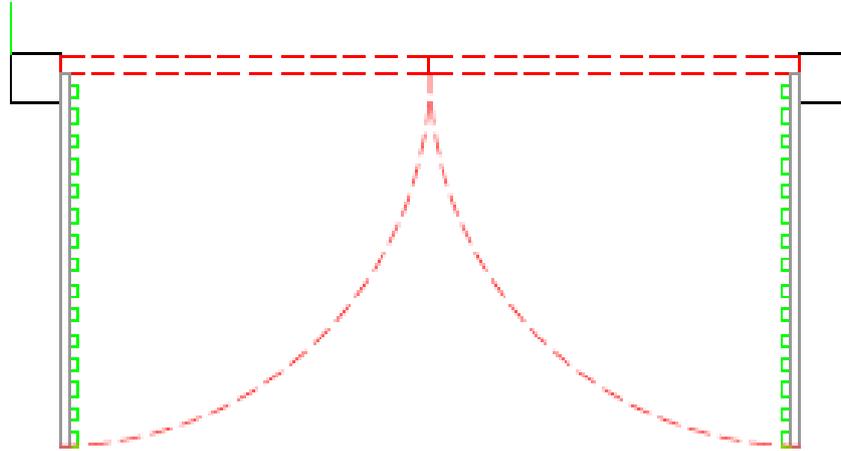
Vista en planta de la puerta batiente a doble hoja de garaje, en posición abierto hacia el exterior de la vivienda.
